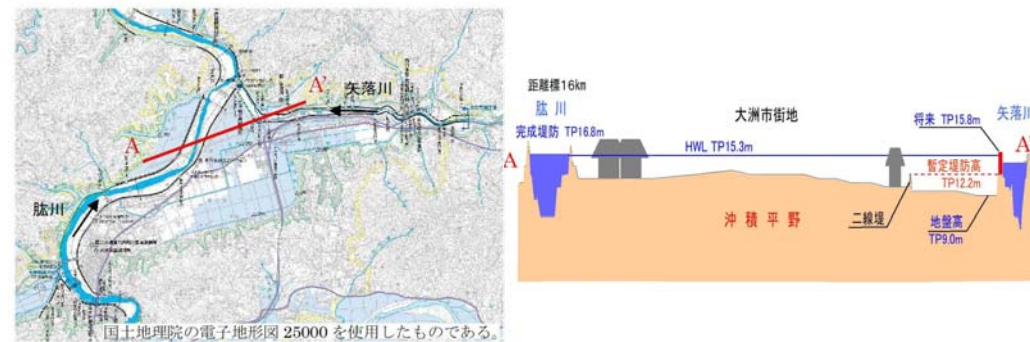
肱川沿川の地盤高（平面図、断面図）
